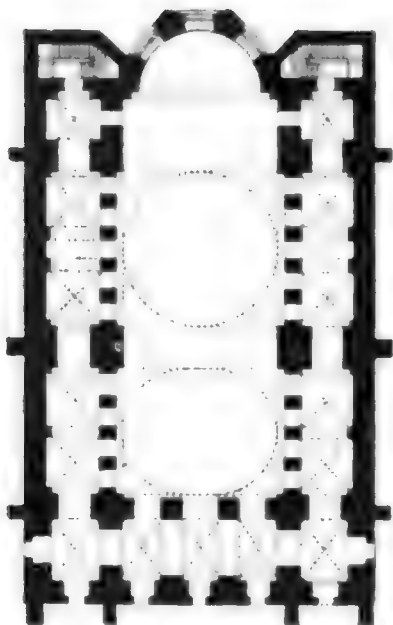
Planta de la iglesia de Santa Eirene. CONSTANTINOPLA.
